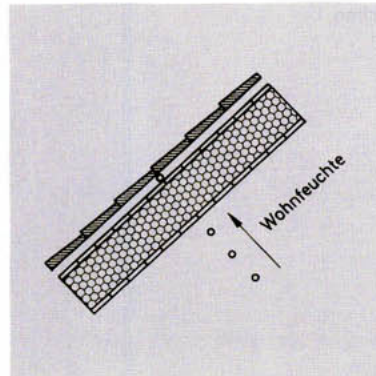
Schematische Darstellung des Aufbaus einer nicht belüfteten, wärmedämmten Satteldachkonstruktion mit Wärmedämmung zwischen den Sparren. Die Unterspannbahn bzw. Vordeckung muß dampfdurchlässig sein; ihr s_d -Wert muß auf den der raumseitigen Beplankung abgestimmt werden (Faustregel: Diffusionswiderstand der Vordeckung kleiner als der Beplankung). Der Sparrenzwischenraum kann voll mit Wärmedämmstoff ausgefüllt werden. Es ist lediglich mit einer Feuchteeinwirkung aus dem Wohnbereich zu rechnen, die aber bei abgestimmten Diffusionswiderständen zu keiner nachteiligen Feuchteerhöhung führt.
